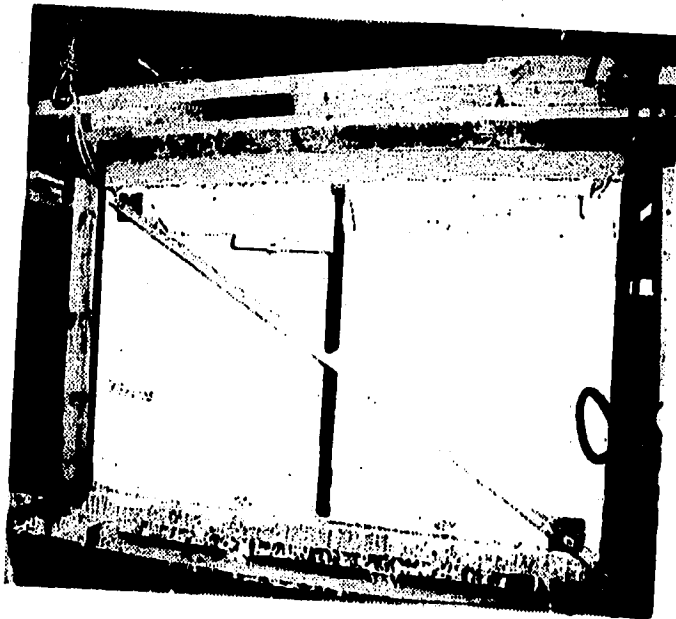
Falla del muro por deslizamiento entre mortero y mampuesto.
